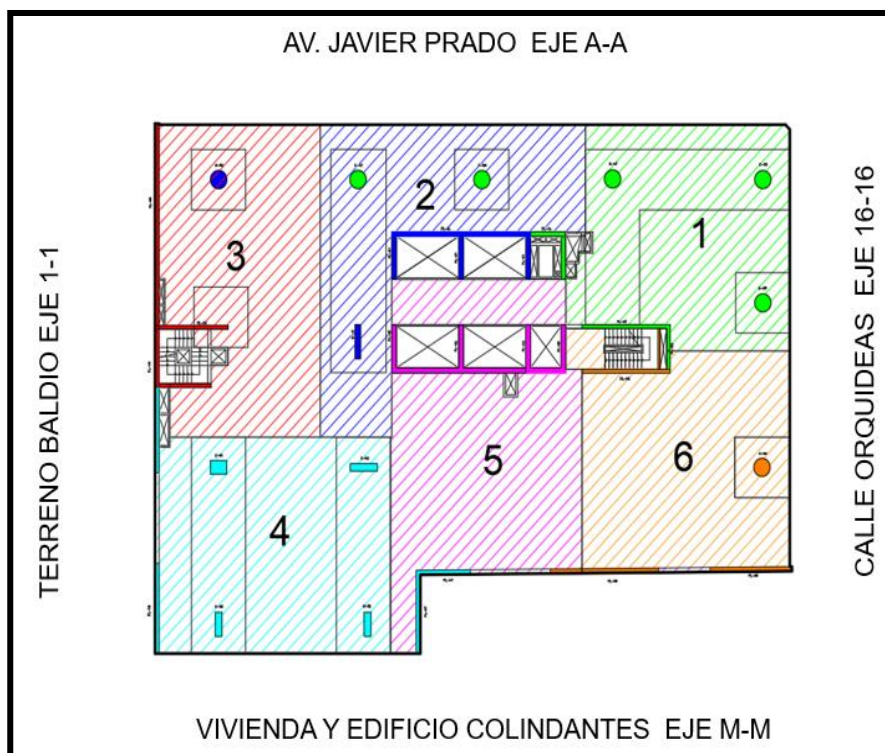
Vista en Planta de la Sectorización de Pisos Superiores 1 al 19
